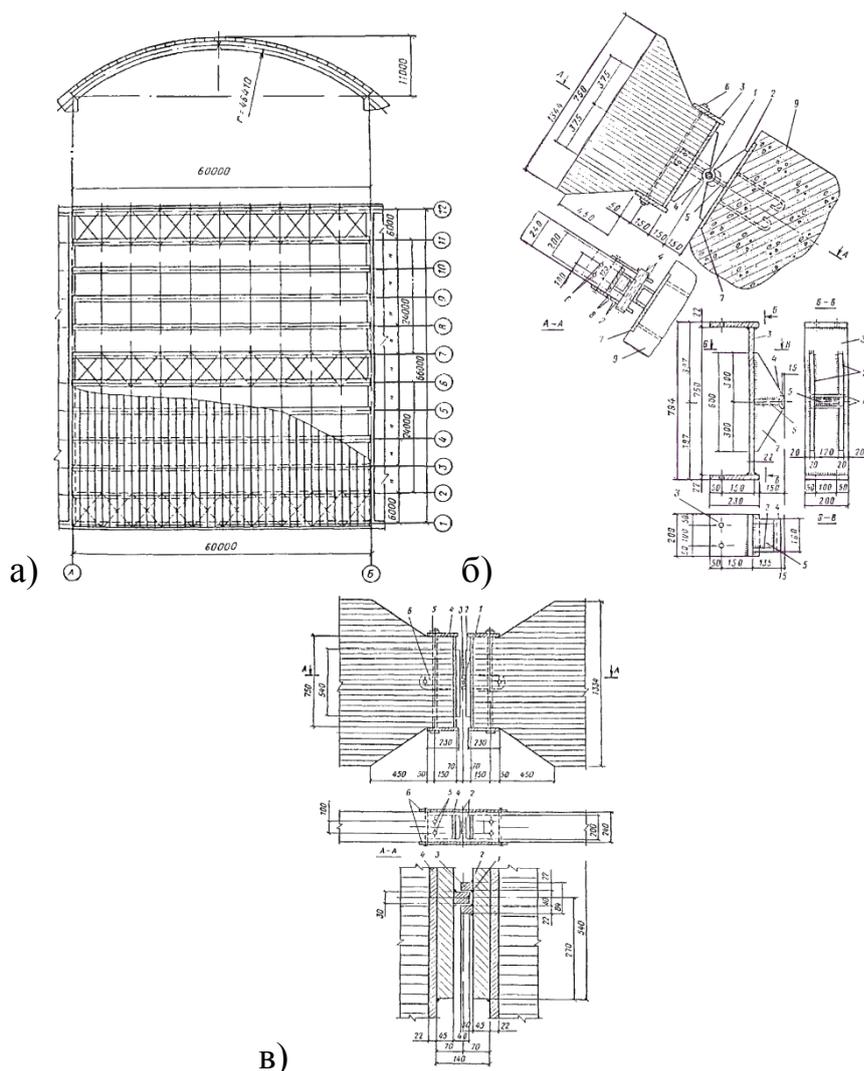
Поперечный разрез и план арочного покрытия здания (а), опорный (б) и коньковый (в) узел арки
